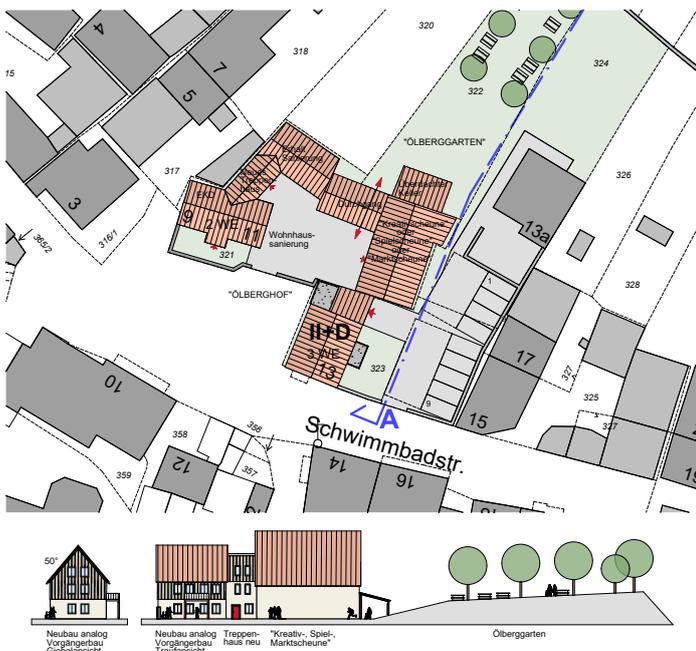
Lageplan - Schwimmbadstraße 9, 11, 13 „Ölberghof“
